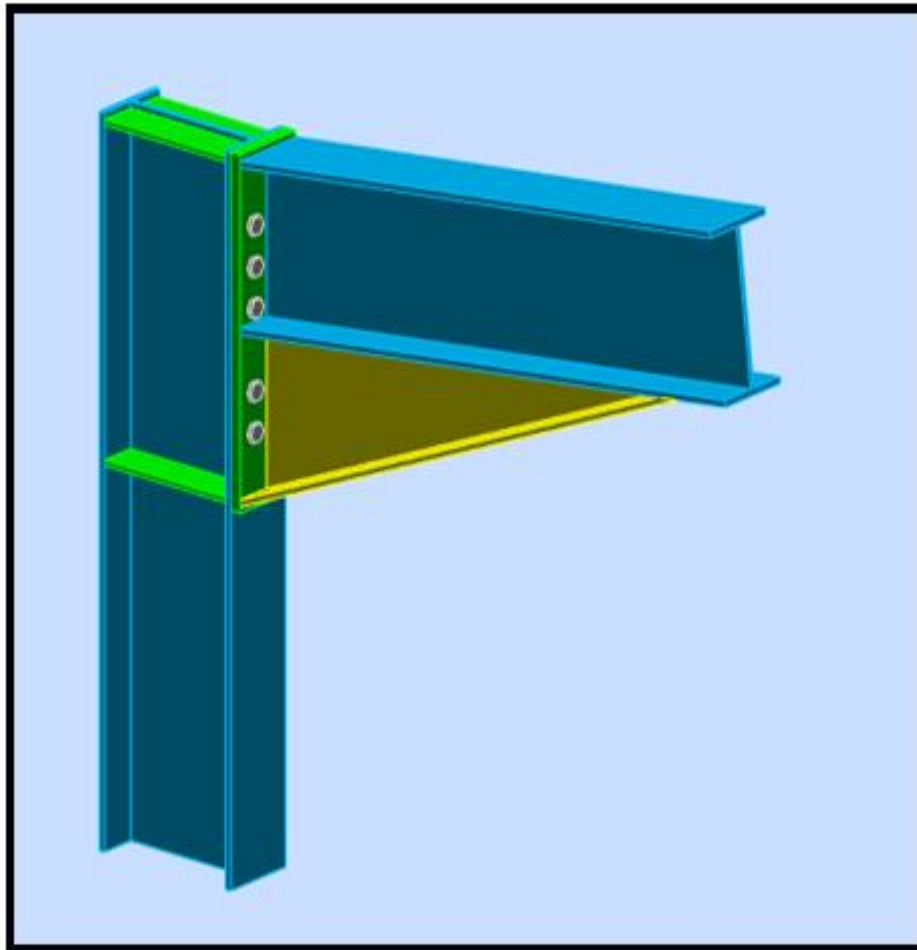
Vue en 3D de l'assemblage poteau-traverse
